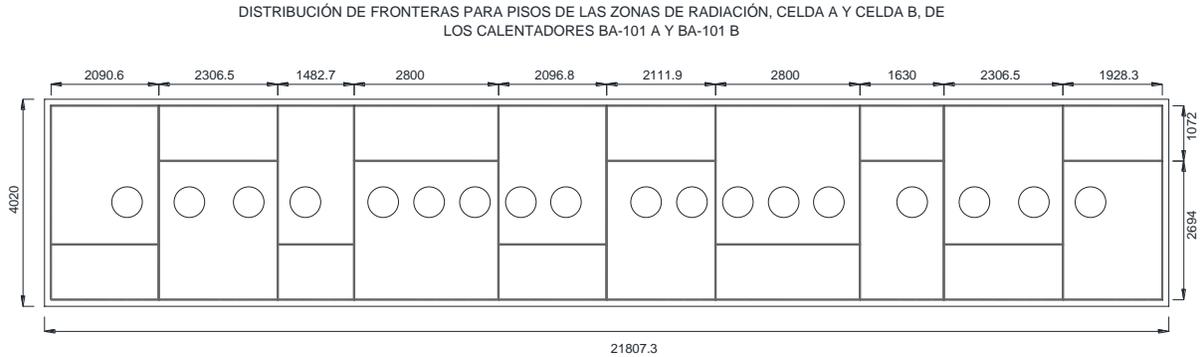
Distribución de juntas de expansión en los pisos de las zonas de radiación. Fuente: Planos del proyecto.
